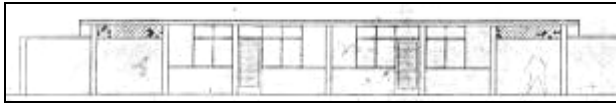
c. Vivienda LV-1. Fachada (1952)
